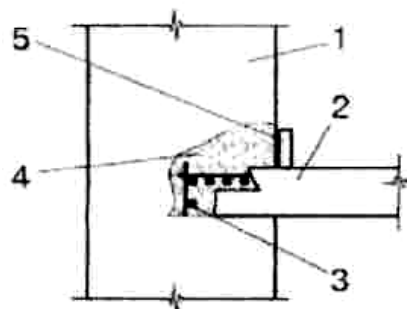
Схема підсилення плити перекриття затисканням на опорах: 1 – існуюча стіна; 2 – плита, що підсилюється; 3 – арматура; 4 – бетон; 5 – опалубка
